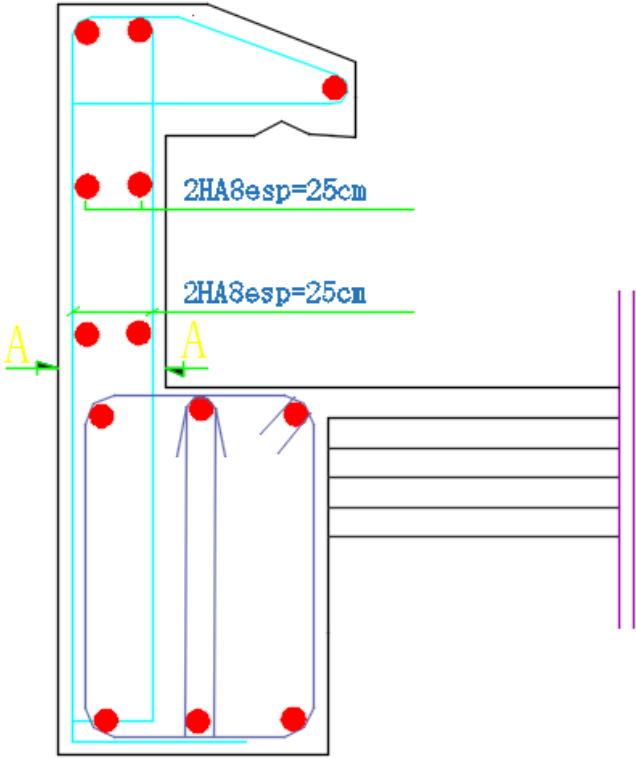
coupe verticale de ferrailage de l'acrotère.
